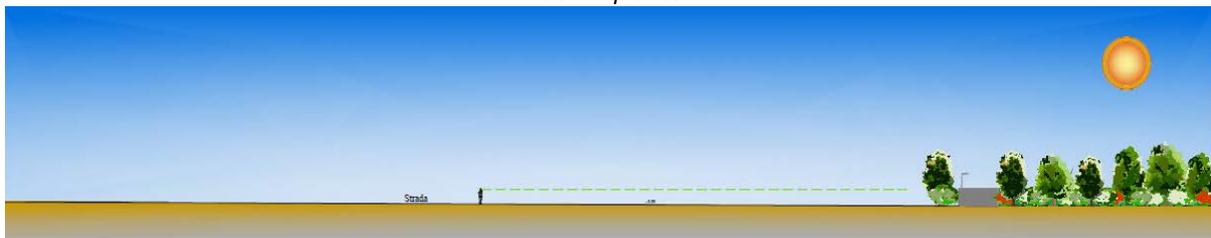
/75 – Punto di vista chiave n. 1 dal lato est, dalla strada del Piano Particolareggiato dell'“AIA” verso l’area dell’impianto
